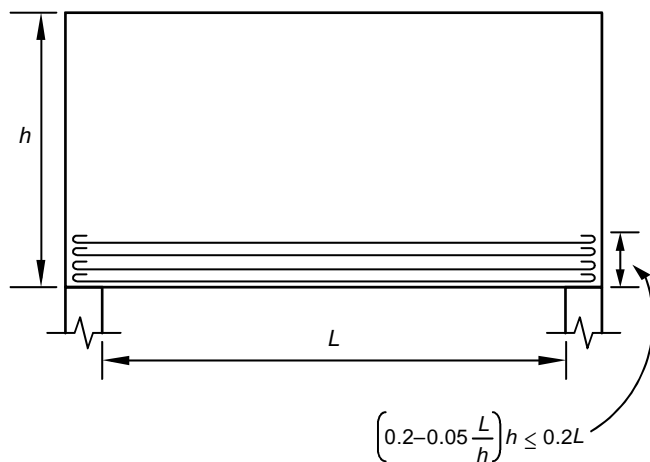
Disposición del refuerzo de flexión en una viga diafragma de un claro
